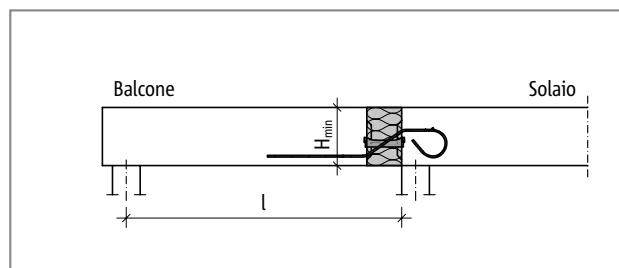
Schöck Isokorb® tipo QXT: sistema statico (tipo da QXT10 a QXT40)
